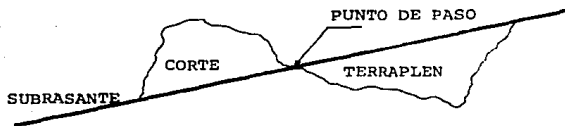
b Ilustración de Corte y Terraplén en terracerías.
